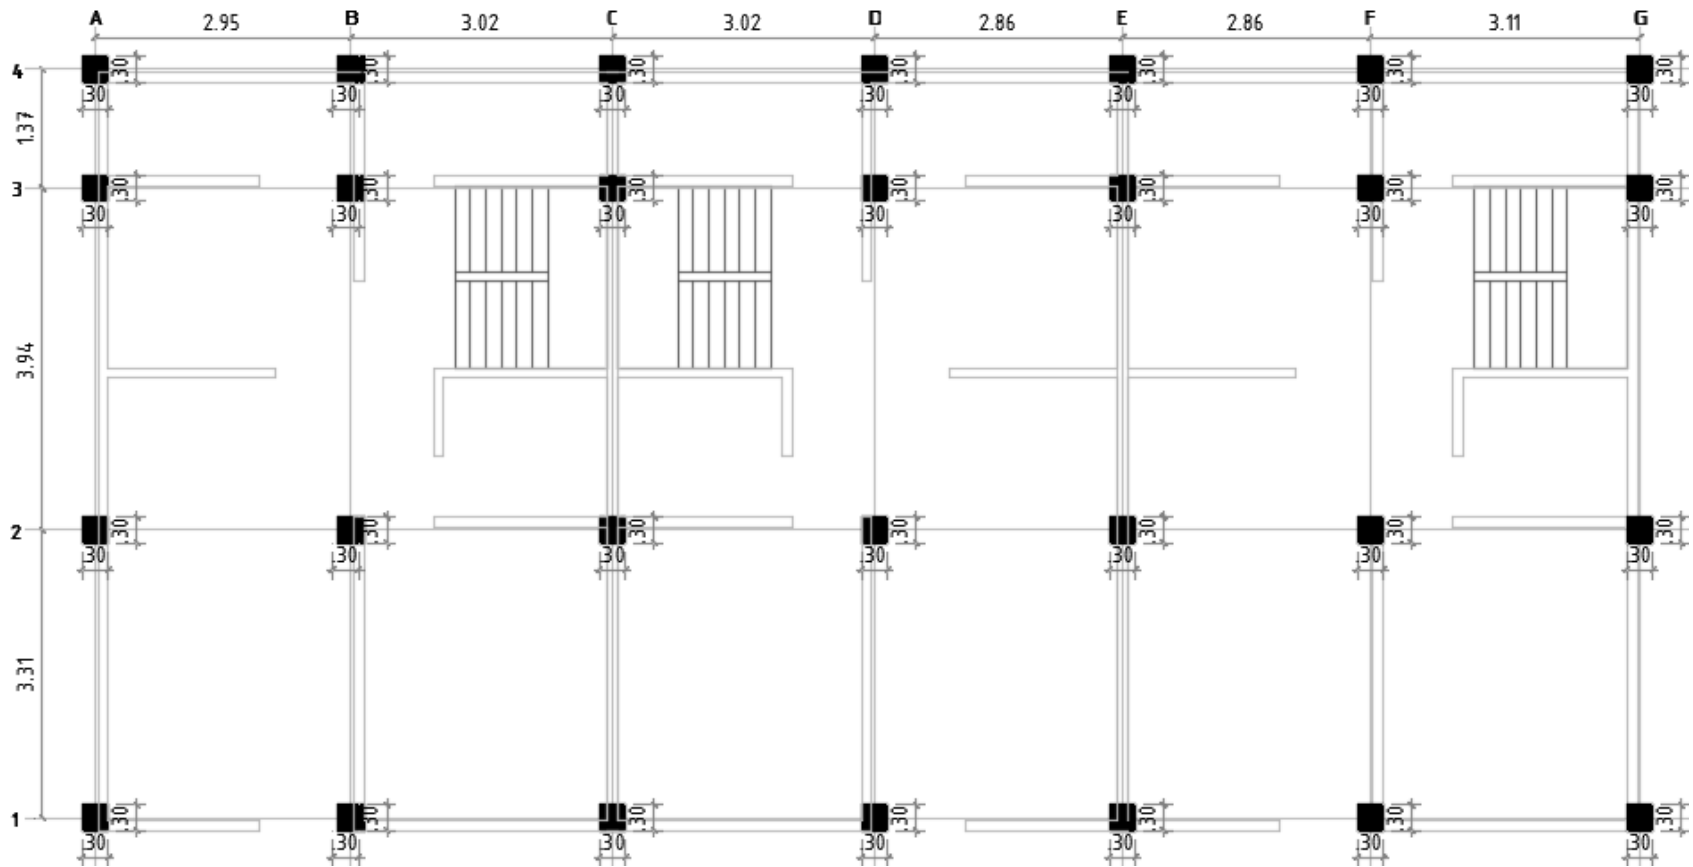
Replanteo de pórticos de viviendas de dos pisos (planta nivel 1)
